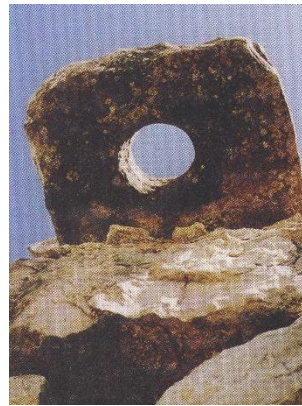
Gorroneira para encajar la puerta. Fuente: F. Miralles.
